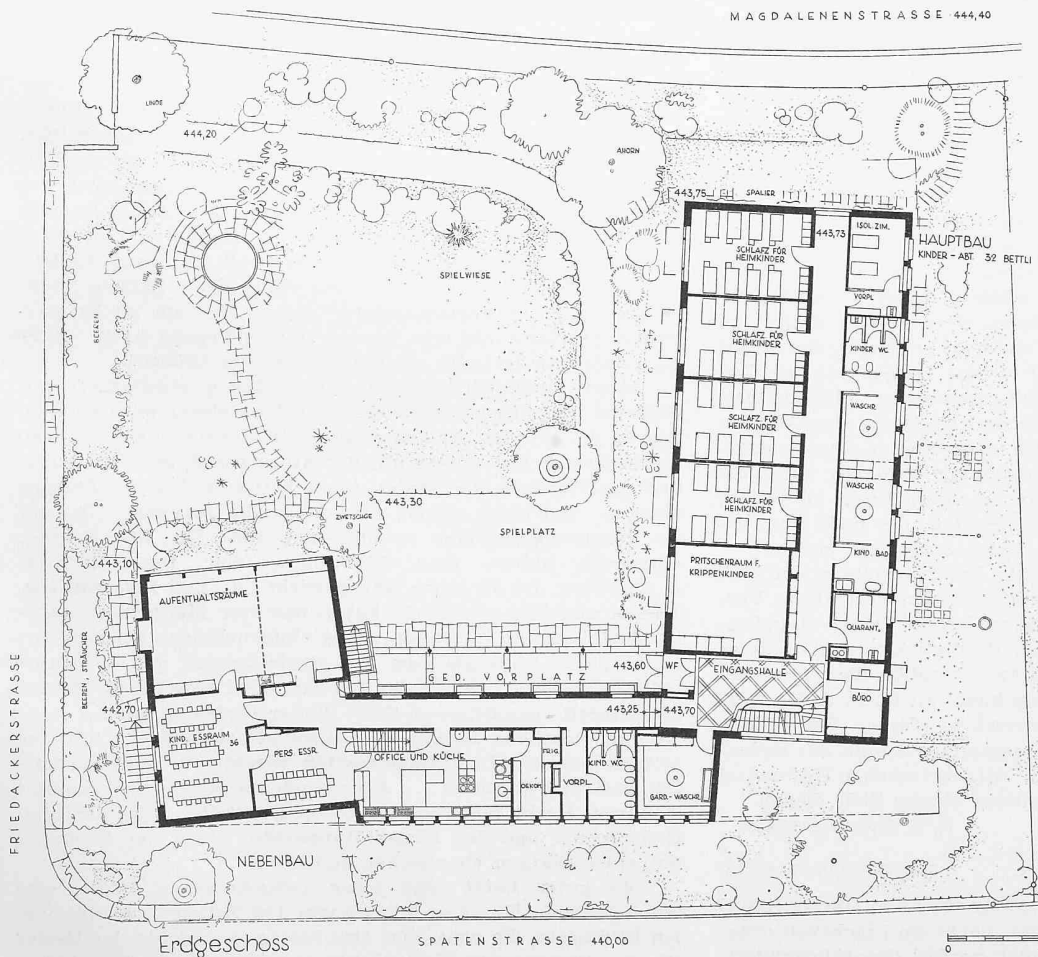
Haupt- und Nebenbau, Erdgeschoss 1:400
